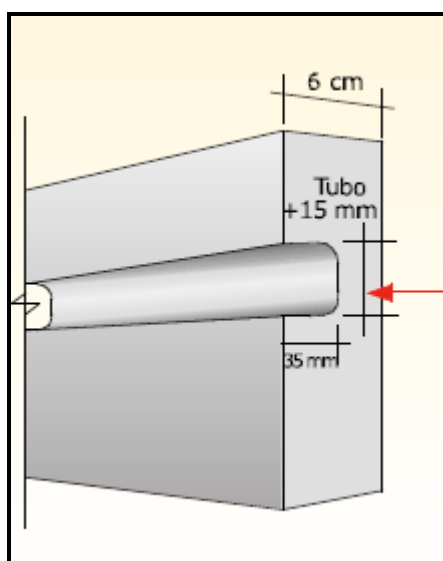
Detalhe do corte no bloco para as instalações (ISOMUR, 2007)
